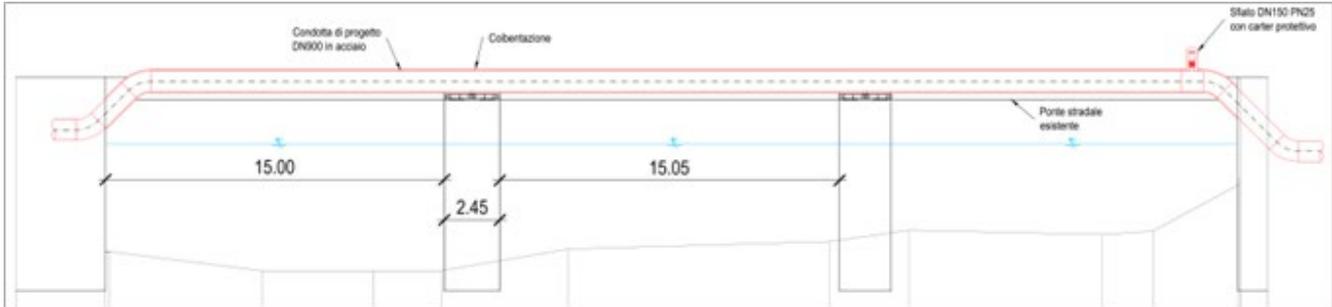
Sezione longitudinale attraversamento aereo di progetto sul fiume Aventino.
